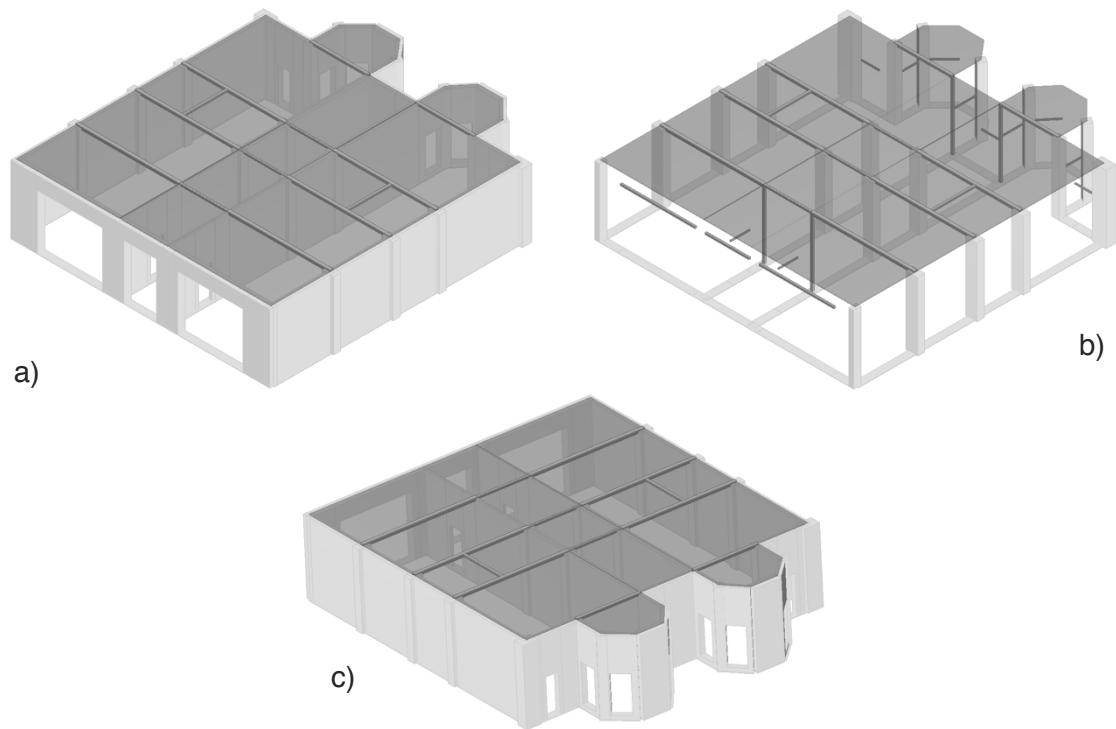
Modelo Tremuri edificio ED-02 planta baja. a) Vista isométrica fachada principal. b) Vista isométrica fachada principal sin muros. c) Vista isométrica fachada trasera
